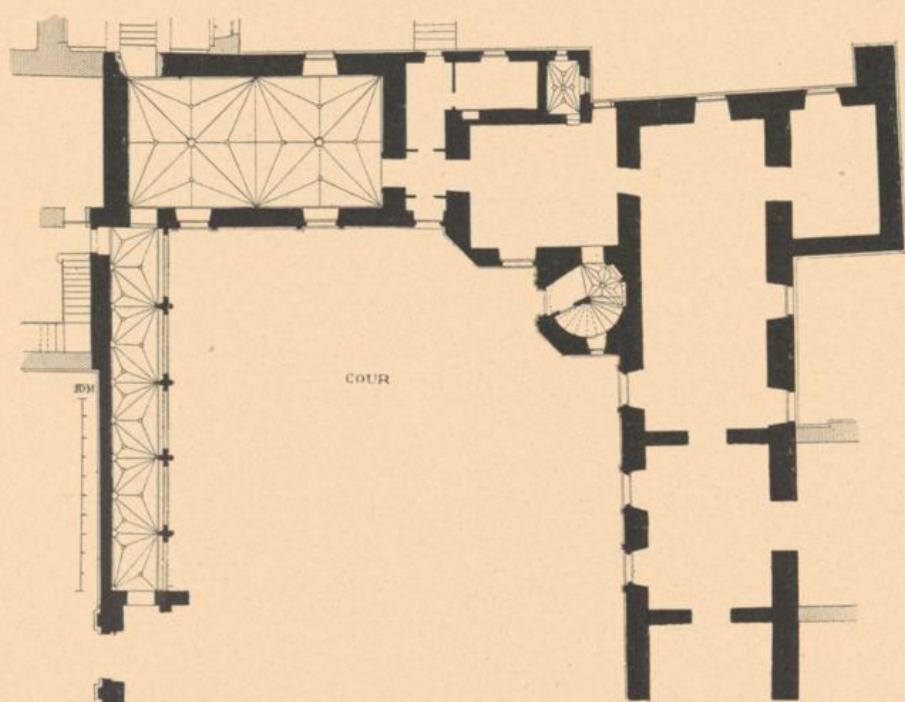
ANGERS: LOGIS BARRAULT. — Plan du rez-de-chaussée
